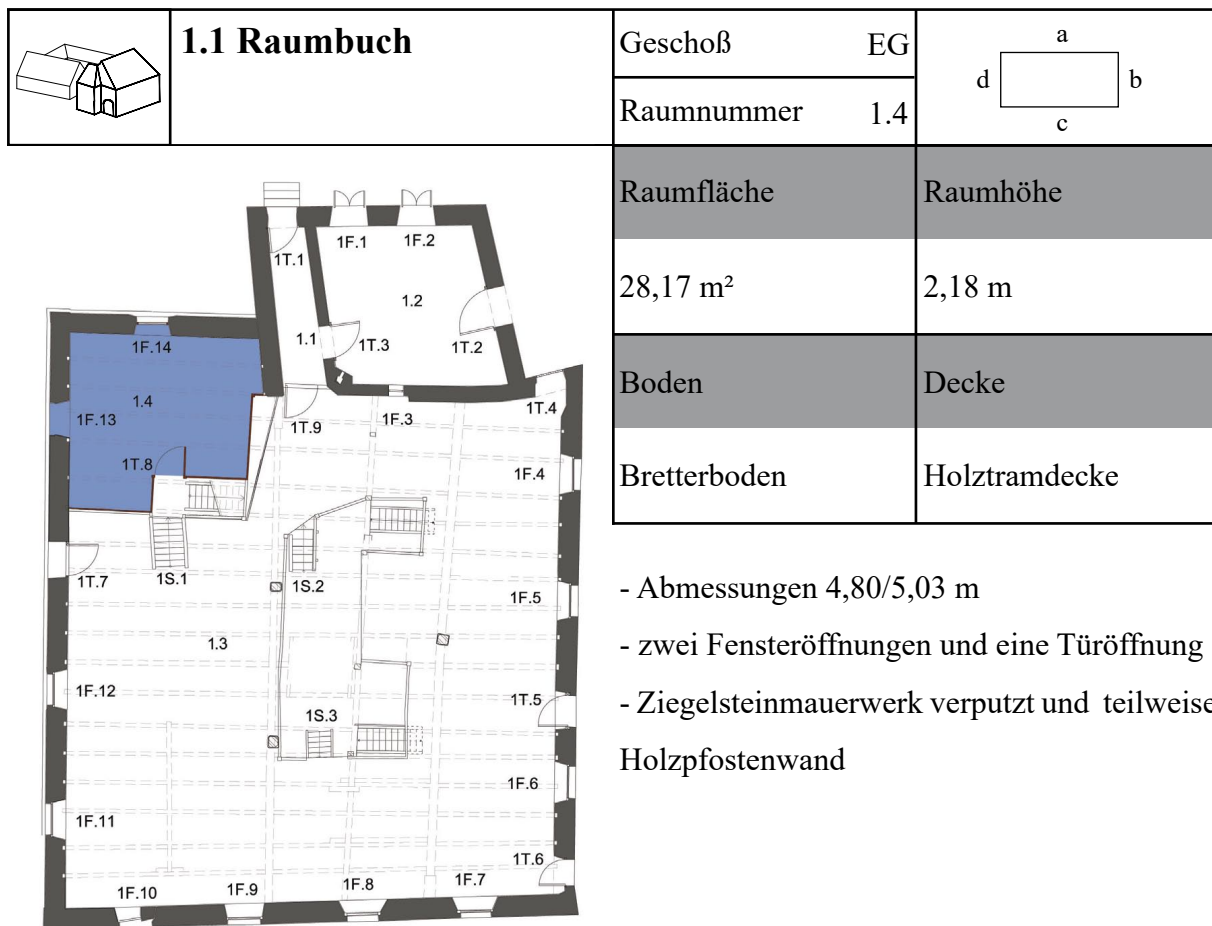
Grundriss Erdgeschoß 1.4
